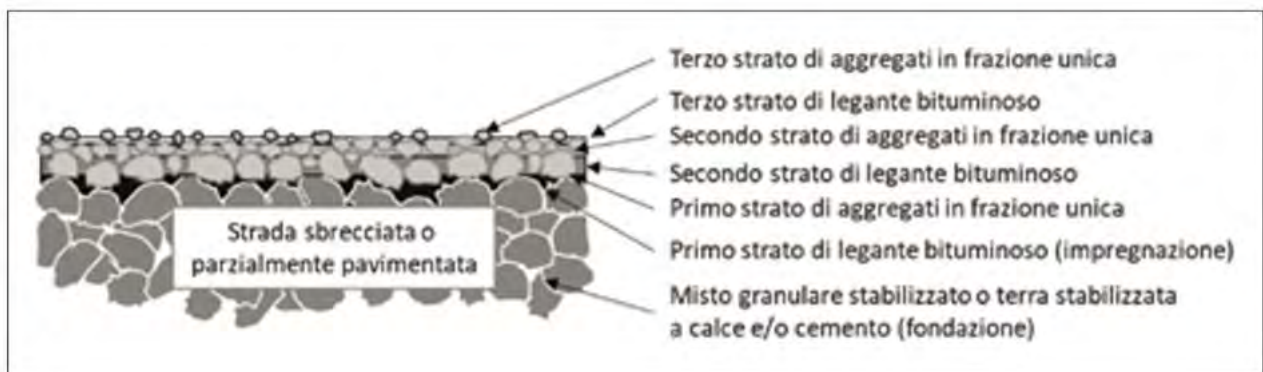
schema tipico di un trattamento con depolverizzazione
